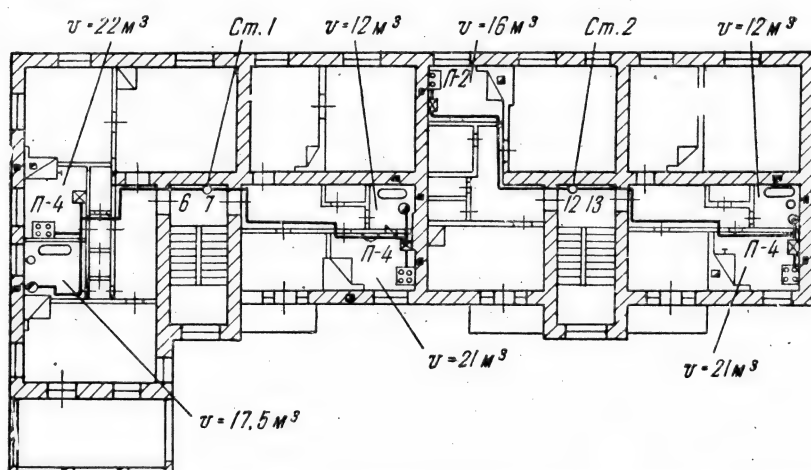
Трассировка газопроводов и размещение газовых приборов на третьем этаже жилого дома.
